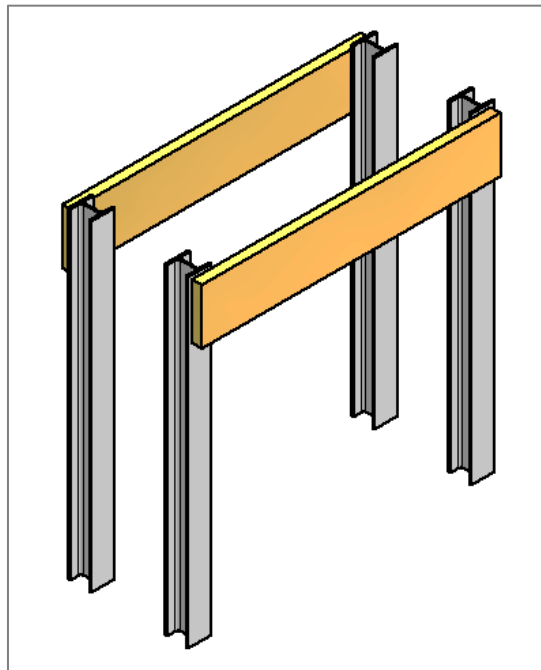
8: Representación preliminar del sistema Viga – Columna. (Elaboración propia, 2 017)
